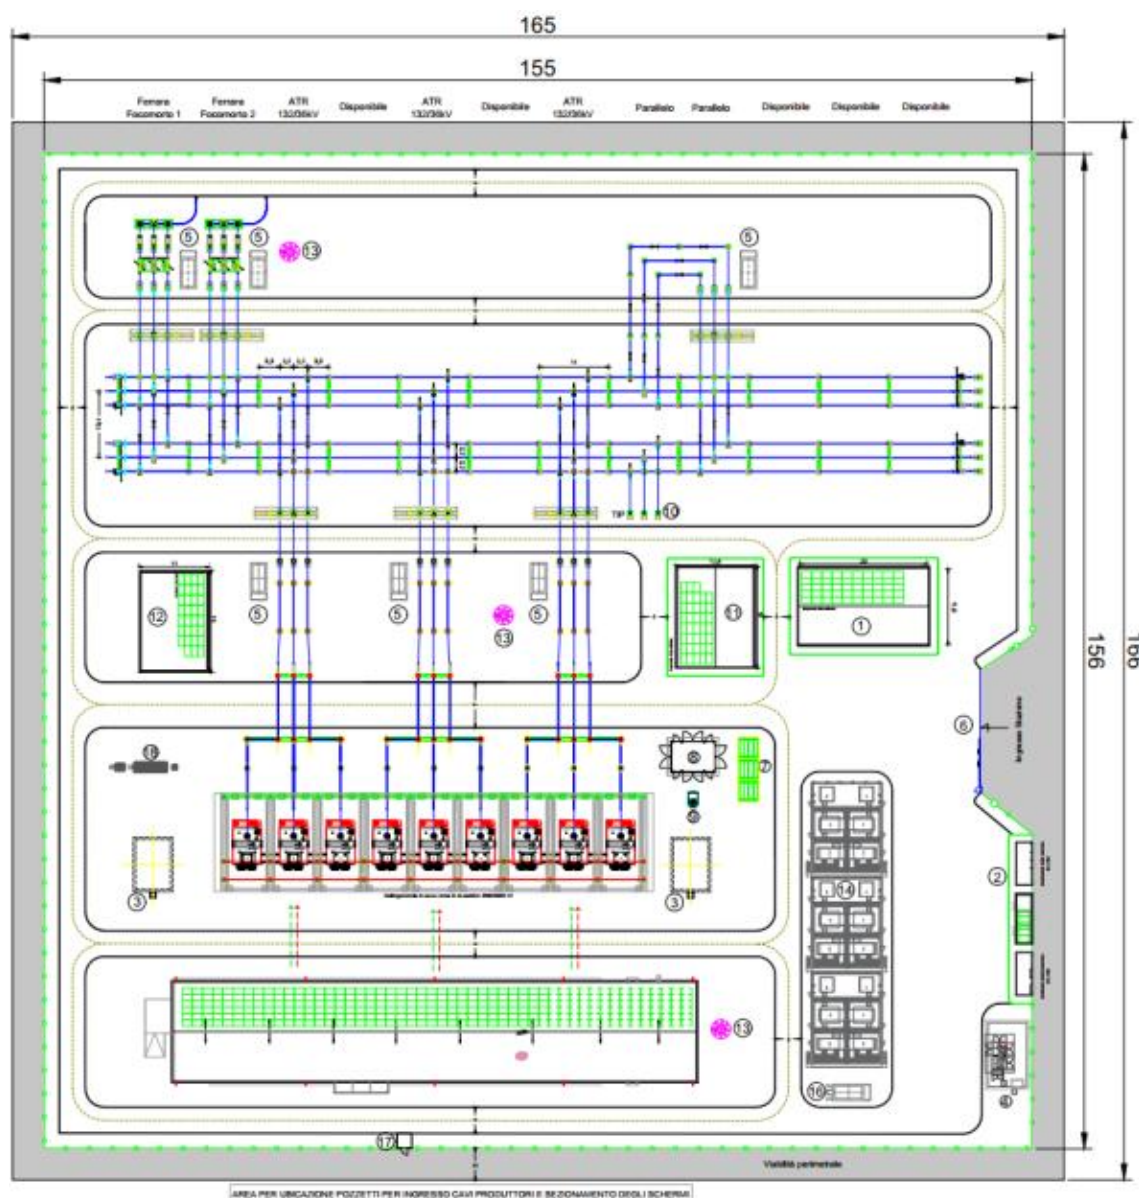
Planimetria elettromeccanica SE RTN 132/36 kV
